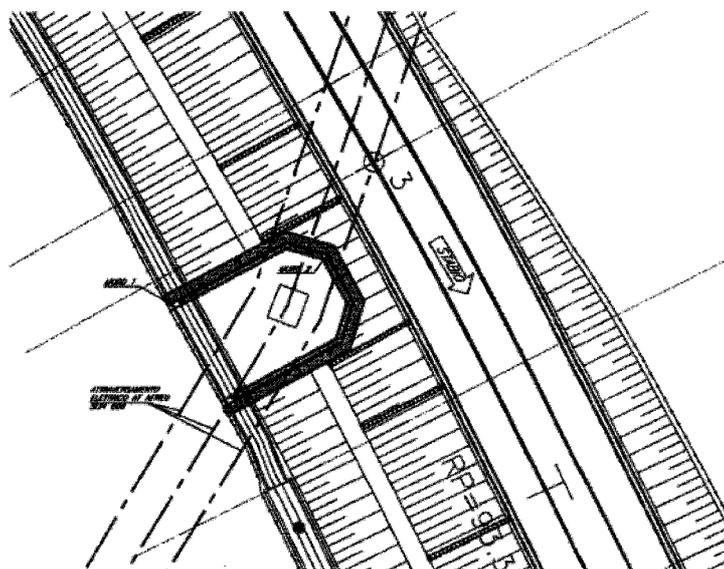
Planimetria della risoluzione dell'interferenza SI34008
